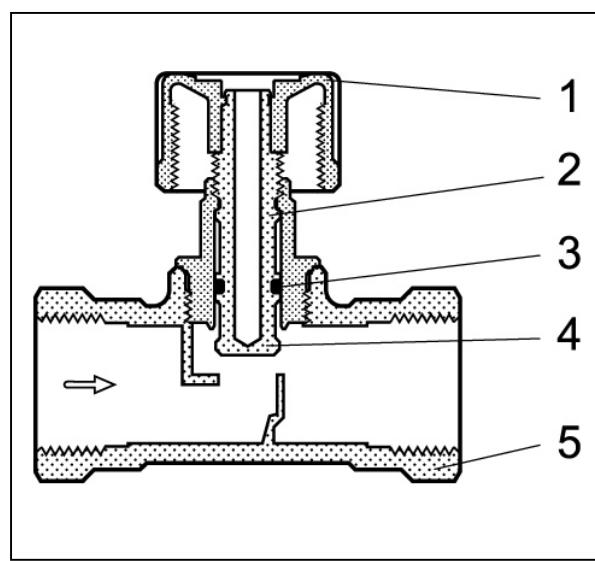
Ручной балансировочный клапан типа MSV-M.
